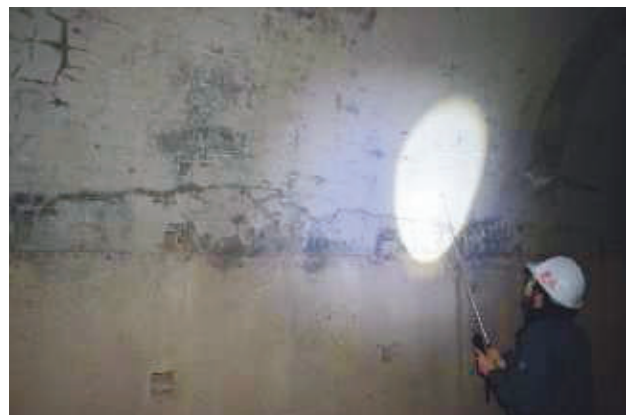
側壁・アーチ接続部の仕上げモルタルのひび割れ
